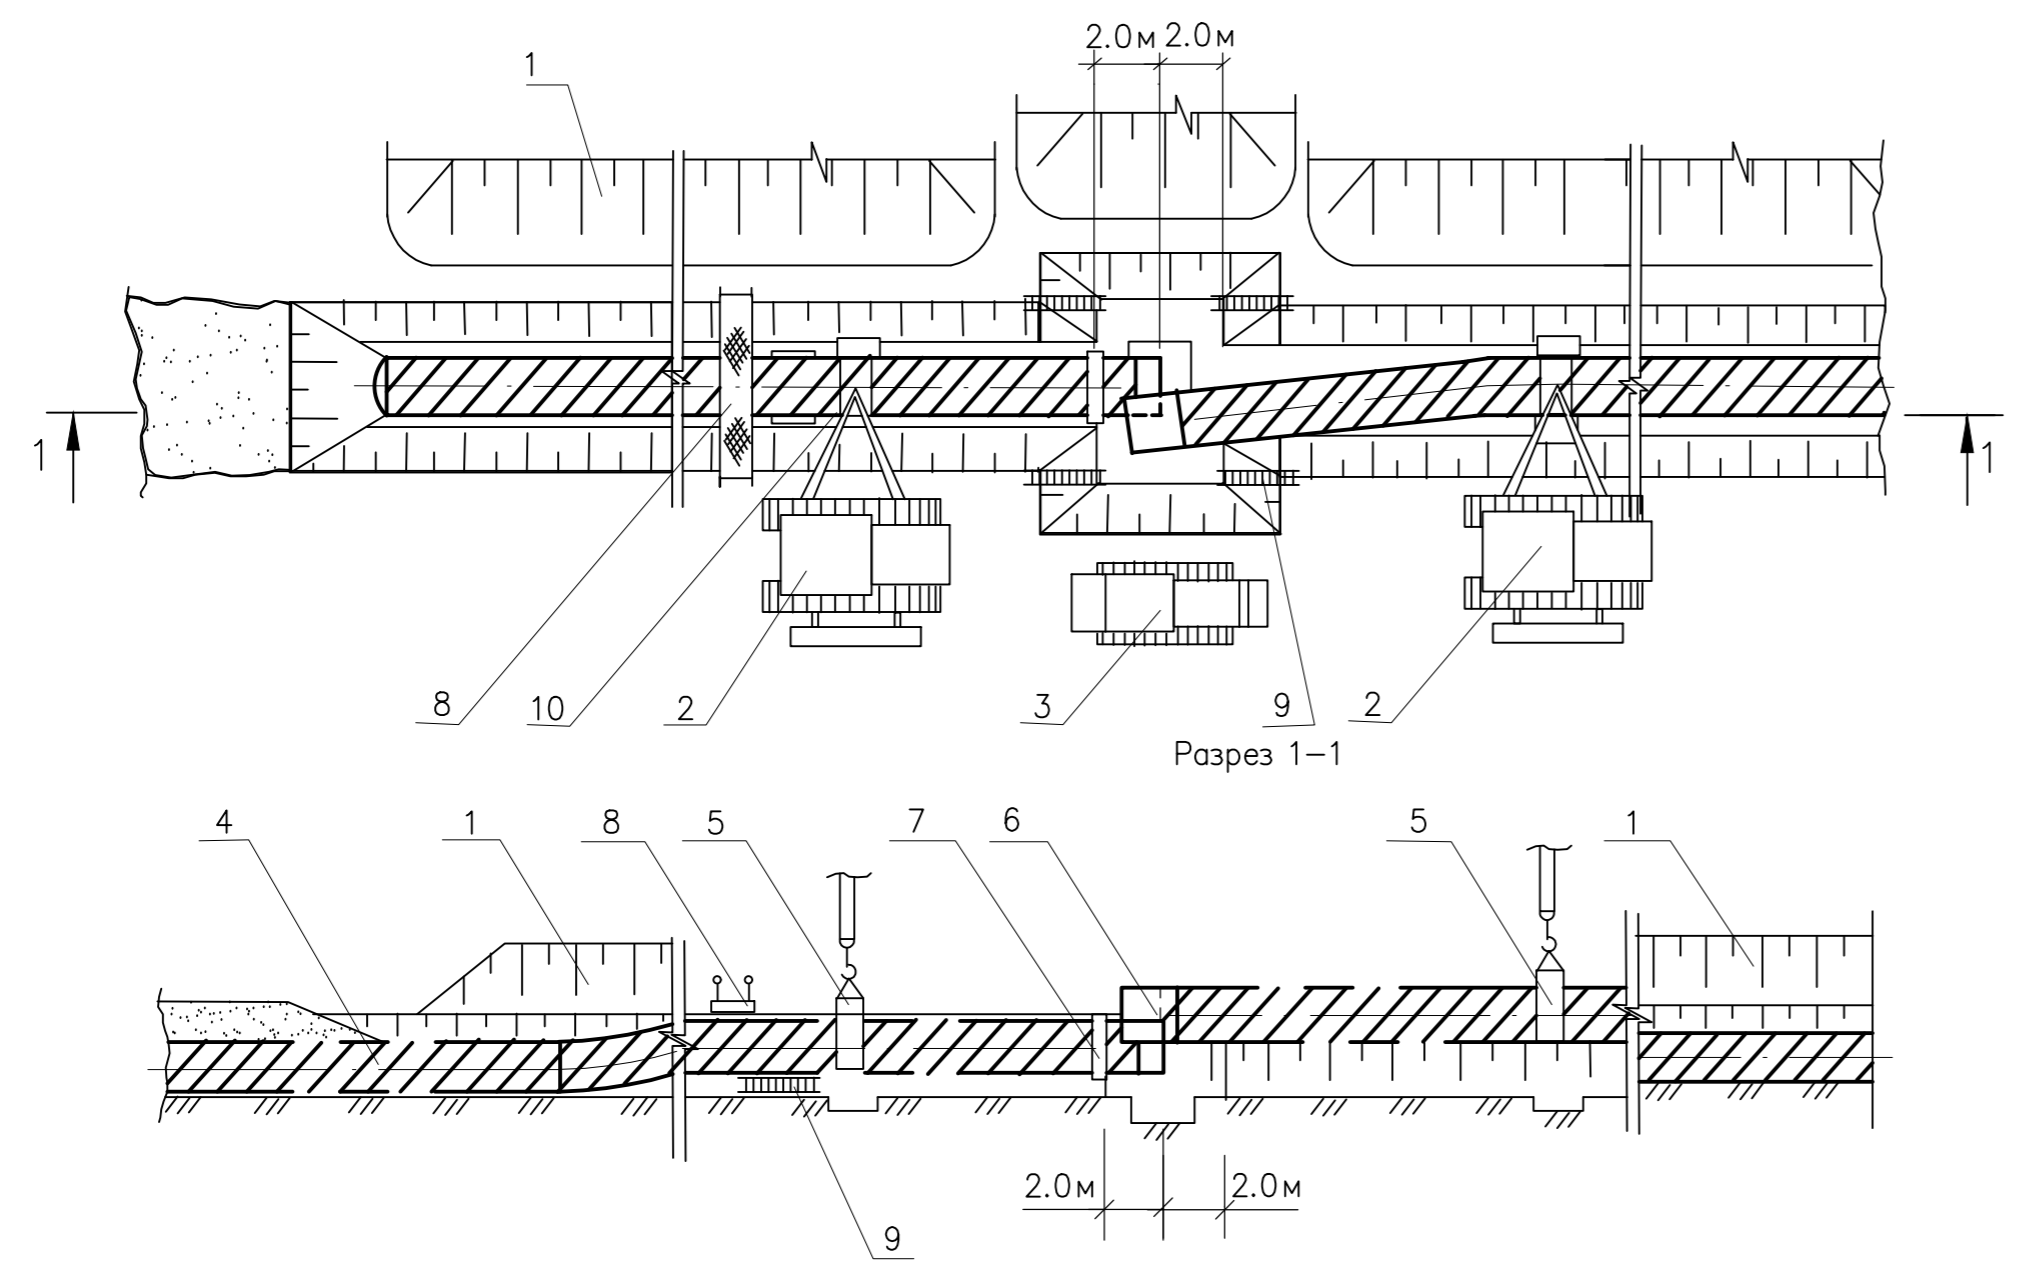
Схема производства работ при монтаже и сварке трубопровода на захлестах
